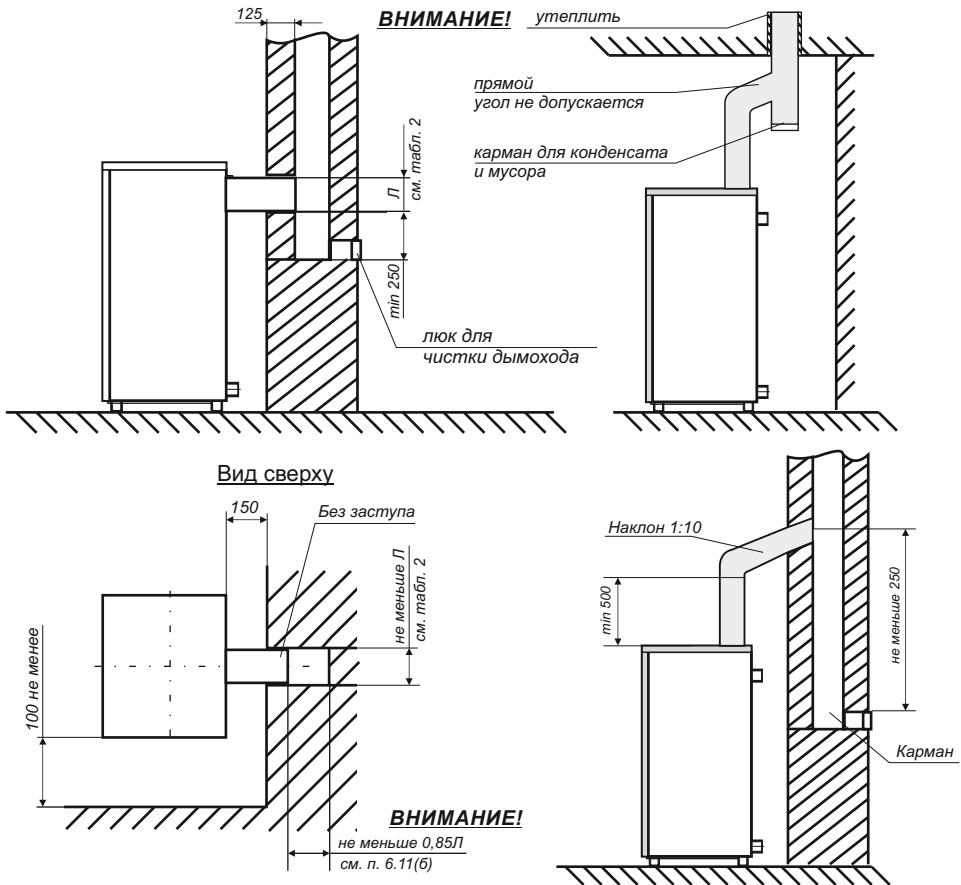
Схема подключения котла к дымовому каналу и план установки котла
